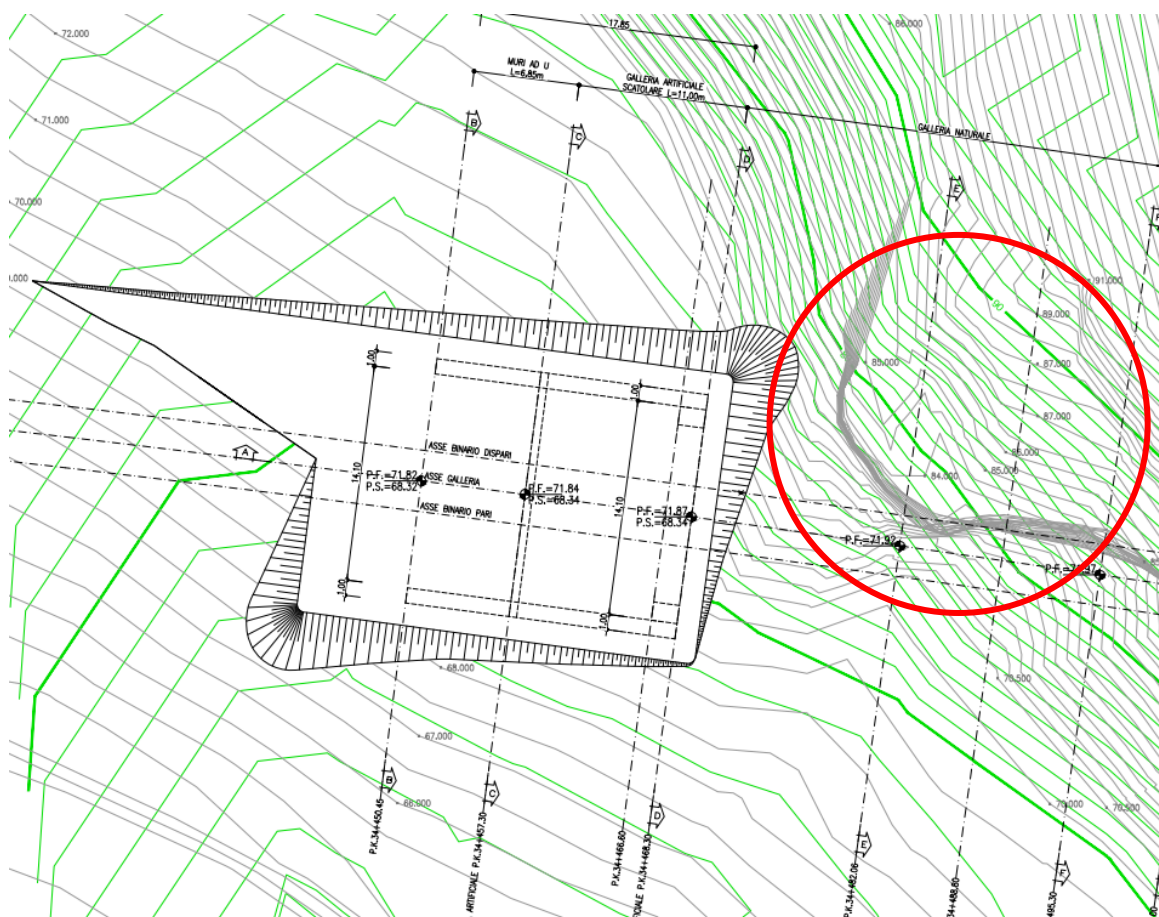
Vista in pianta – Confronto tra profilo altimetrico PD e PE
